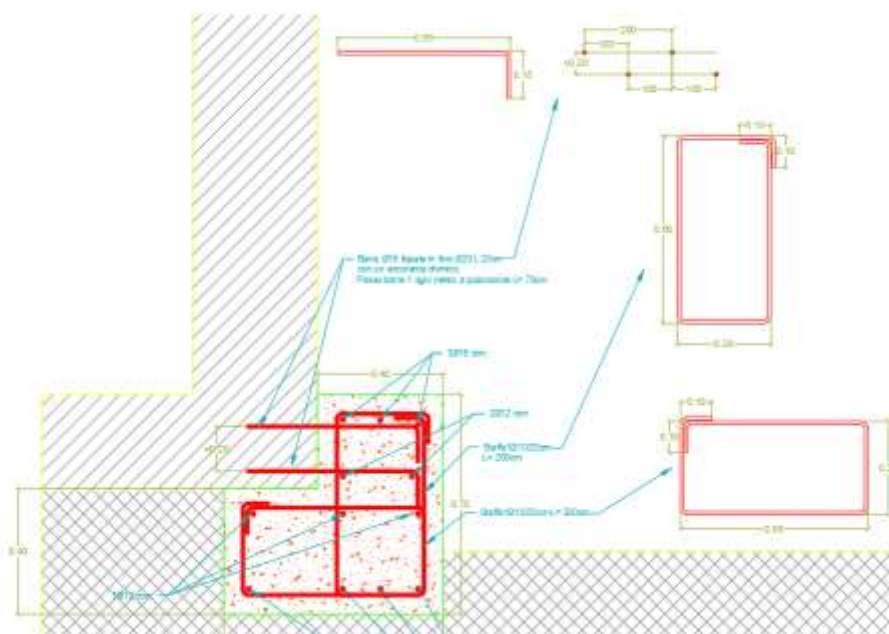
sezione tipologica per ripristino di muro in calcestruzzo tramite sottomurazione
